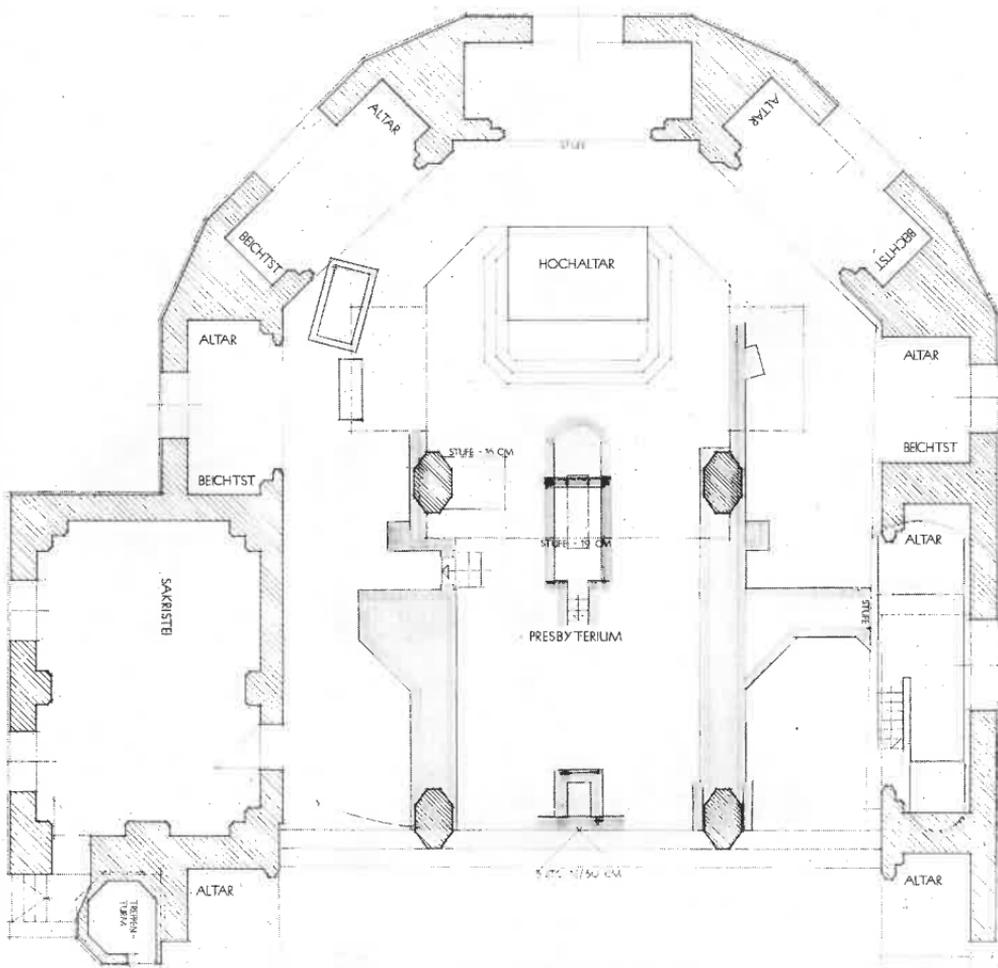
Grundriß des Chorbaues mit festgestelltem Fundament der Vorgängerkirche im Pfeilerbereich.
